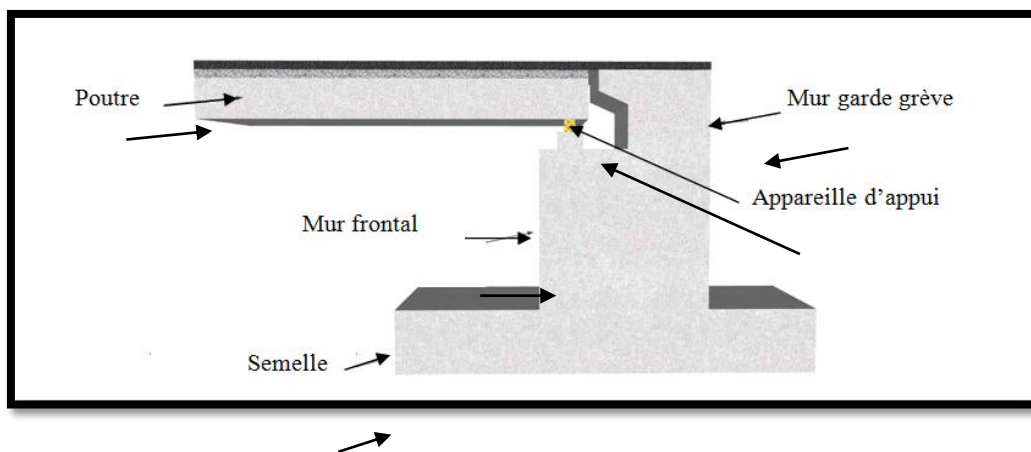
1 : Coupe longitudinale d'une culée d'un pont
